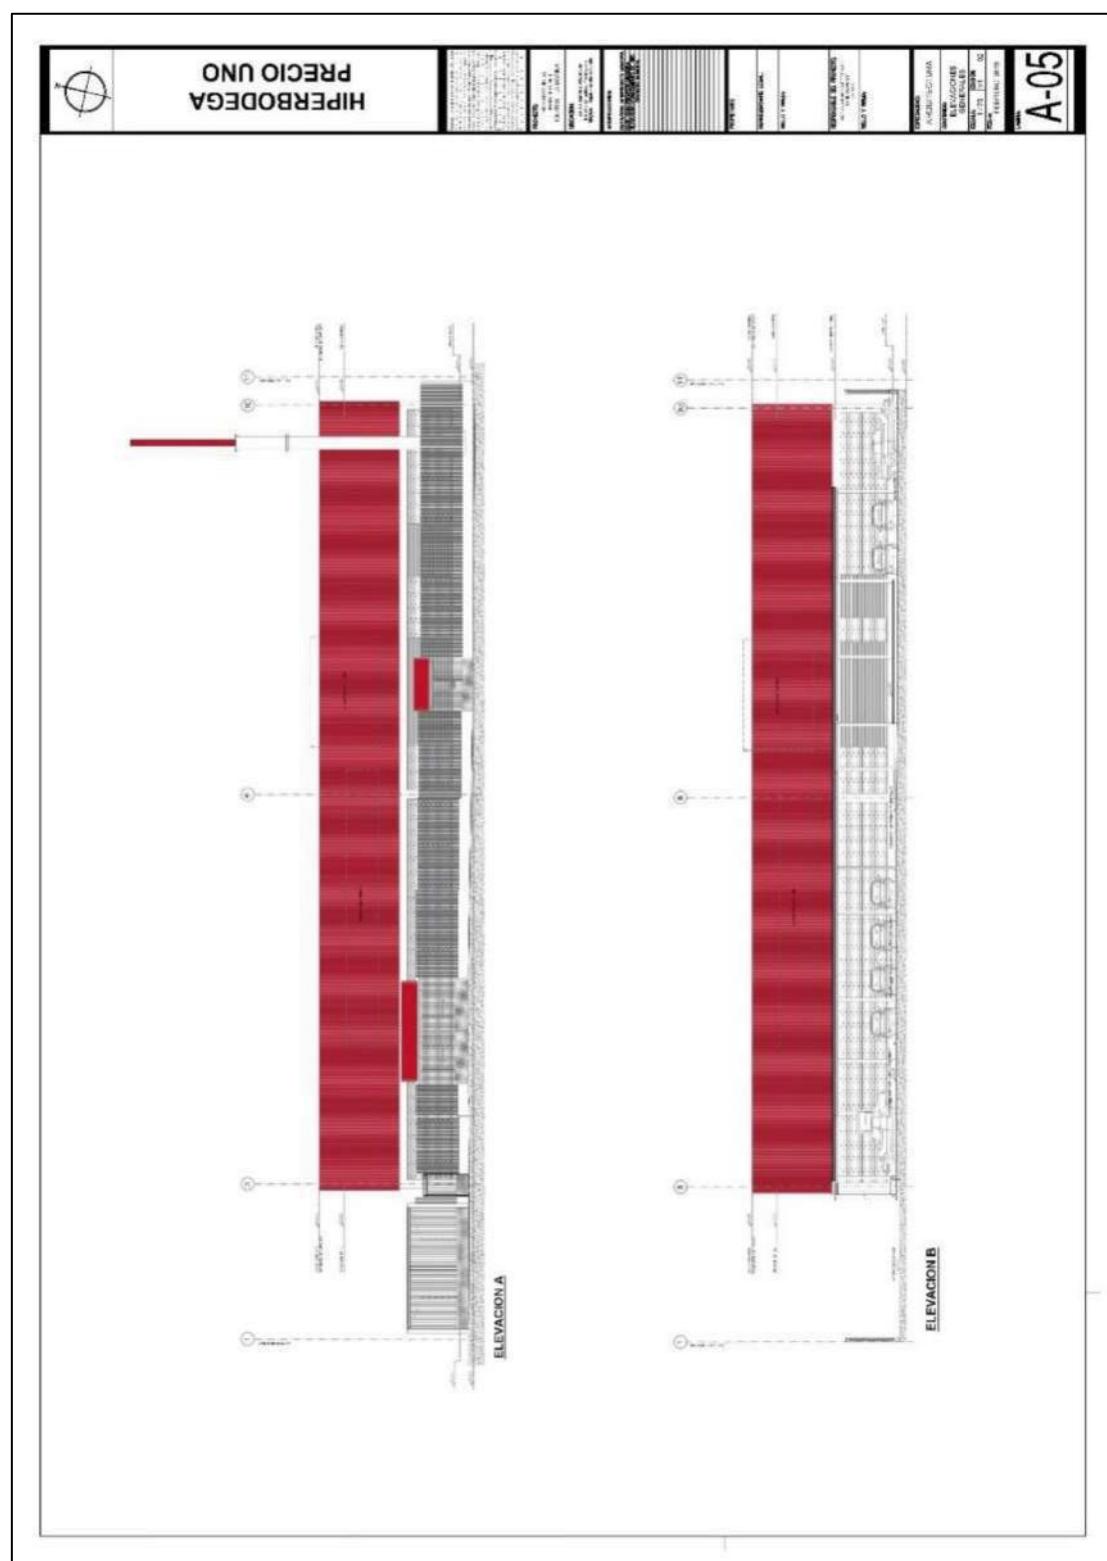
Plano de Elevaciones-2 - Iquitos La Marina
